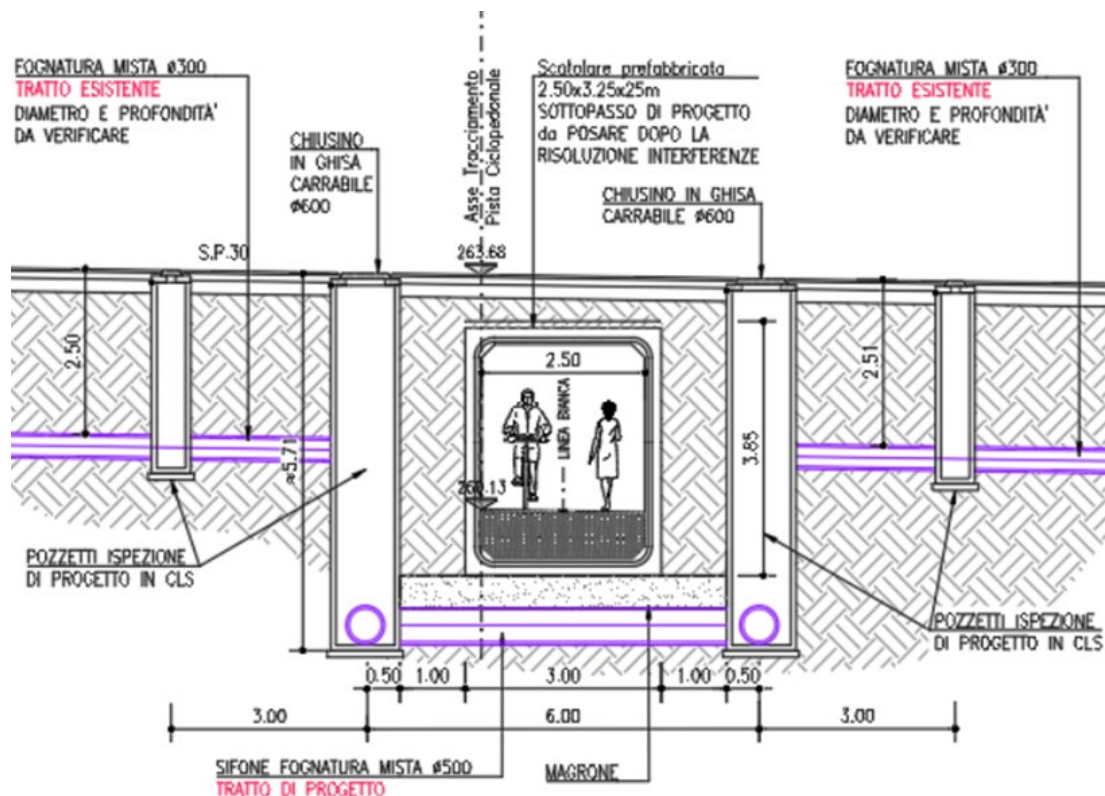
Sezione trasversale sottopassaggio e rete fognaria pubblica di progetto
